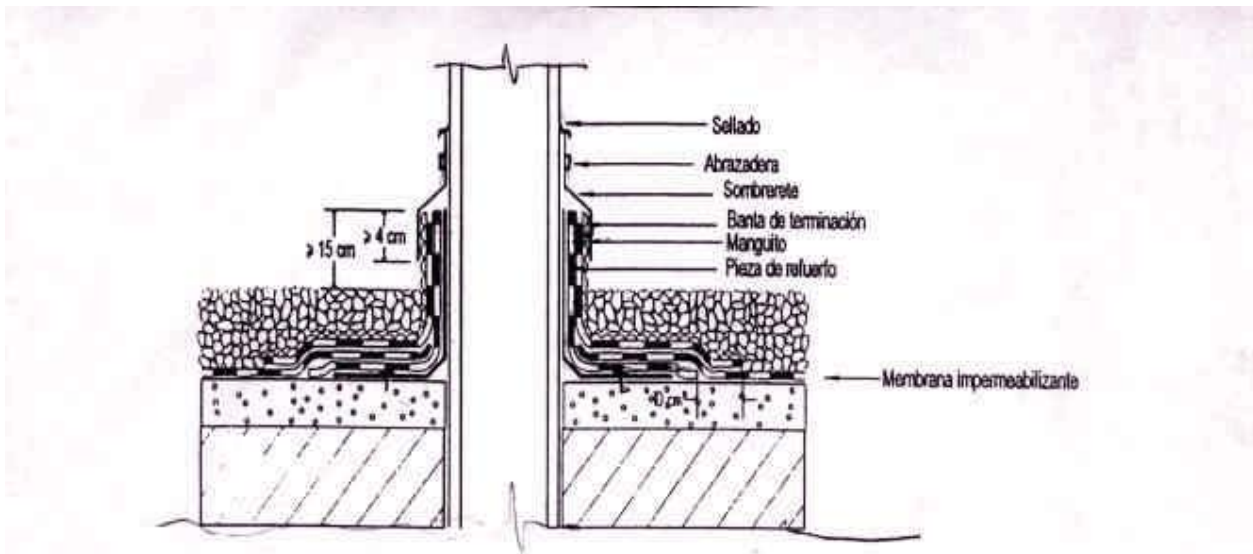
Encuentro de la cubierta con un elemento pasante solucionado con manguito rígido
